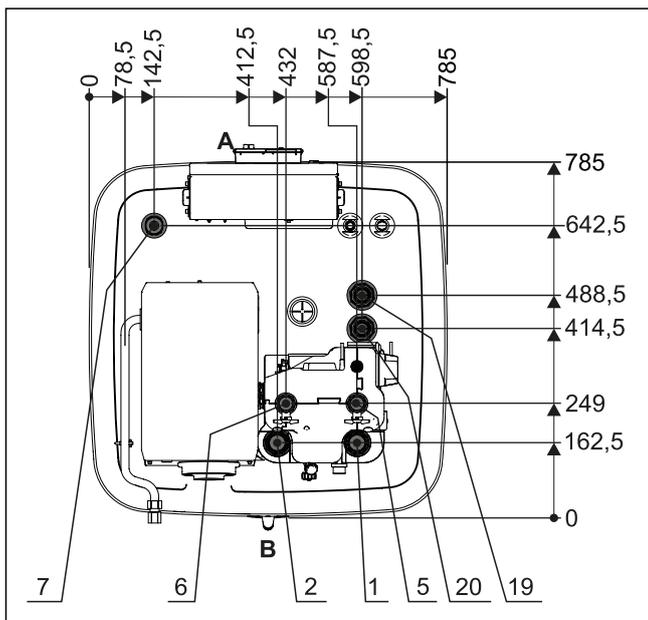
Anschlussmaße GCU compact 5xx (Draufsicht)
